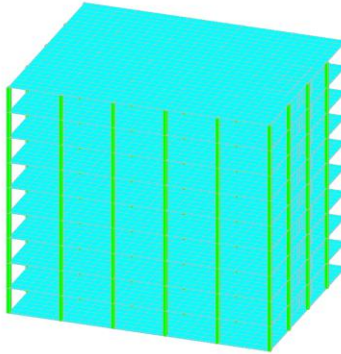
Расчетная схема (монолитный безригельный каркас)
